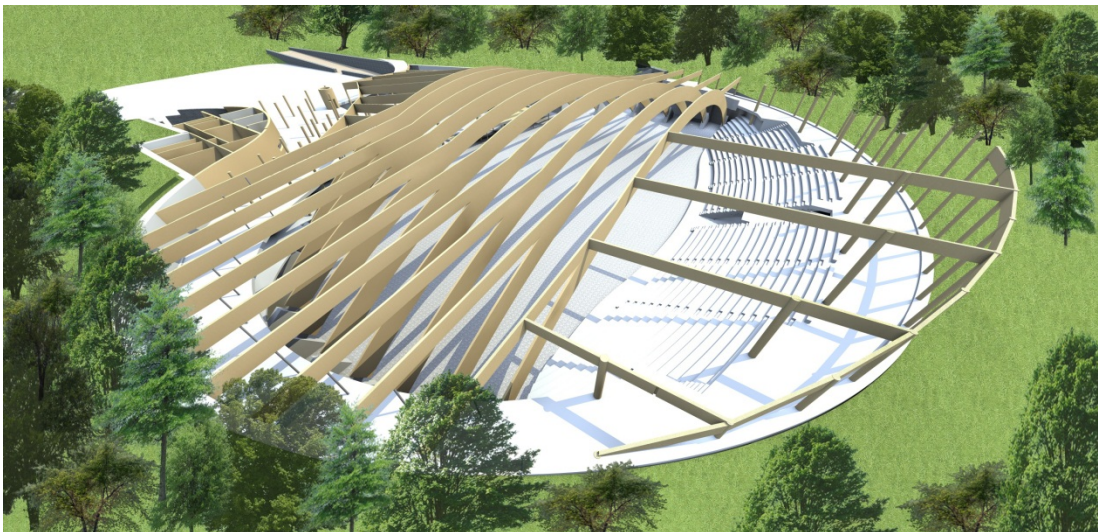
FASE DI CANTIERE – MONTAGGIO STRUTTURA DI COPERTURA 1
